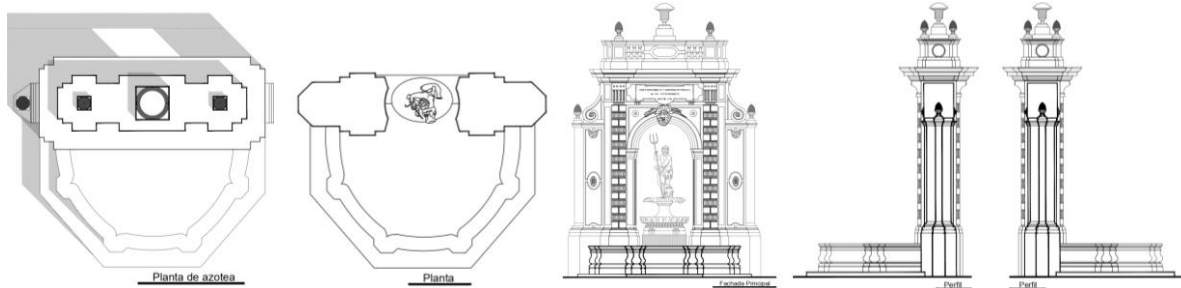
Planta de la cubierta, planta arquitectónica, fachada principal y fachadas laterales de la Fuente de Neptuno en Querétaro. (Fuente propia, 2022).
